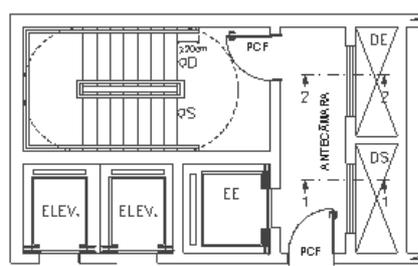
Escada enclausurada à prova de fumaça, com elevador de emergência (posição exemplificativa) na antecâmara.
